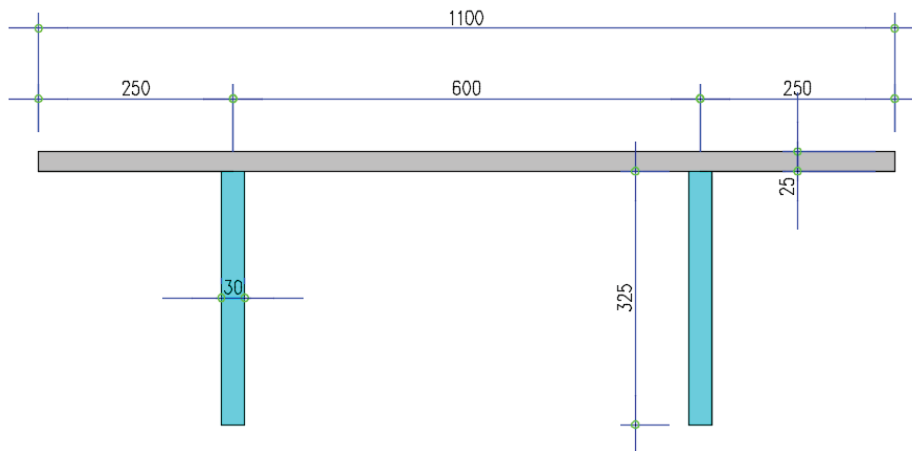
La coupe transversale du pont bipoutre mixte.
